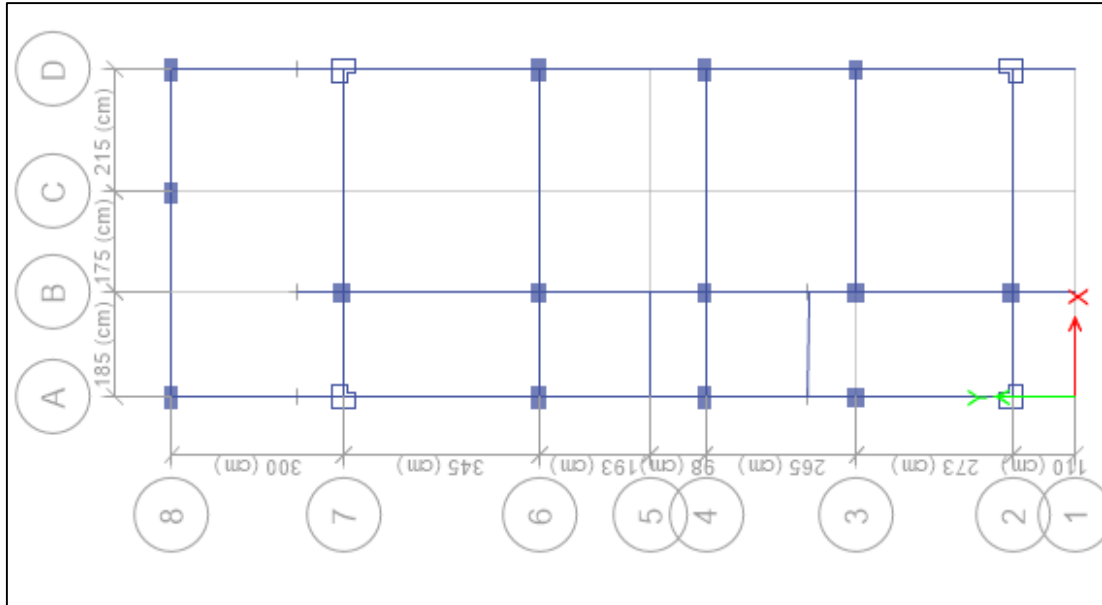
Vista de planta de la estructura modelada en “ETABS”.
